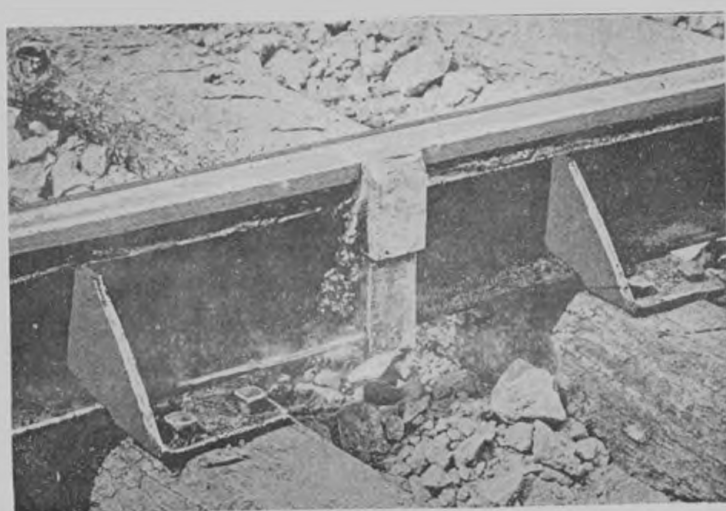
VUE DE LA SOUDURE D'UN RAIL
